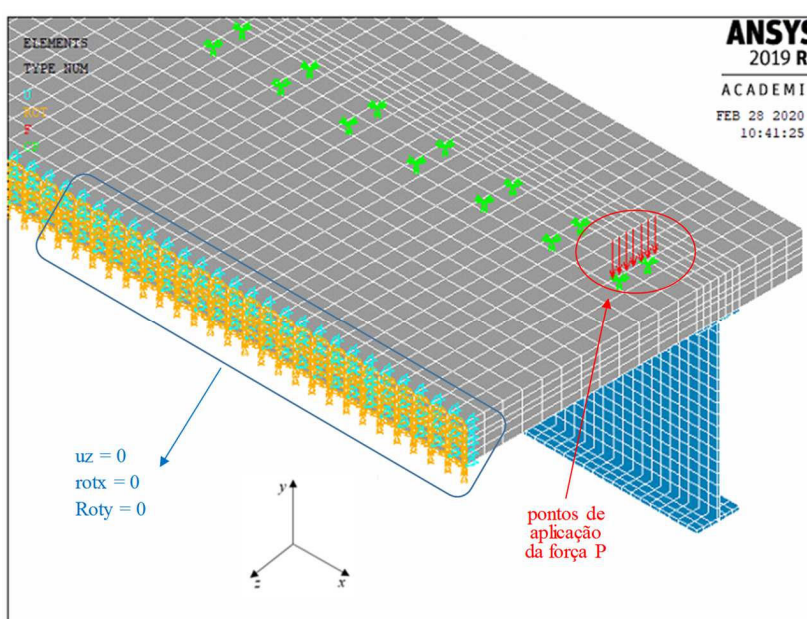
Travamento da laje no plano de simetria e posição do carregamento aplicado no modelo numérico.
